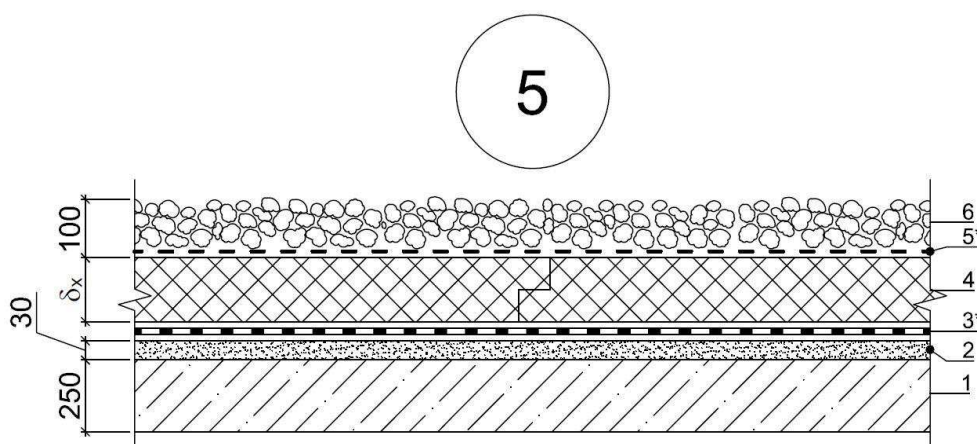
Вариант 5 конструкции покрытия (инверсионного)
